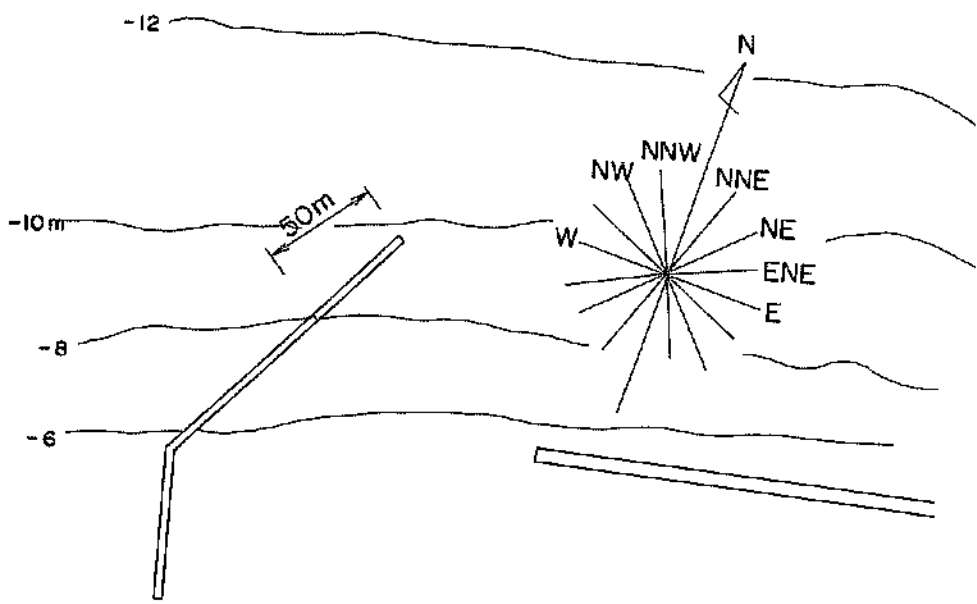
平面図・標準断面図 (㊸西防波堤)
